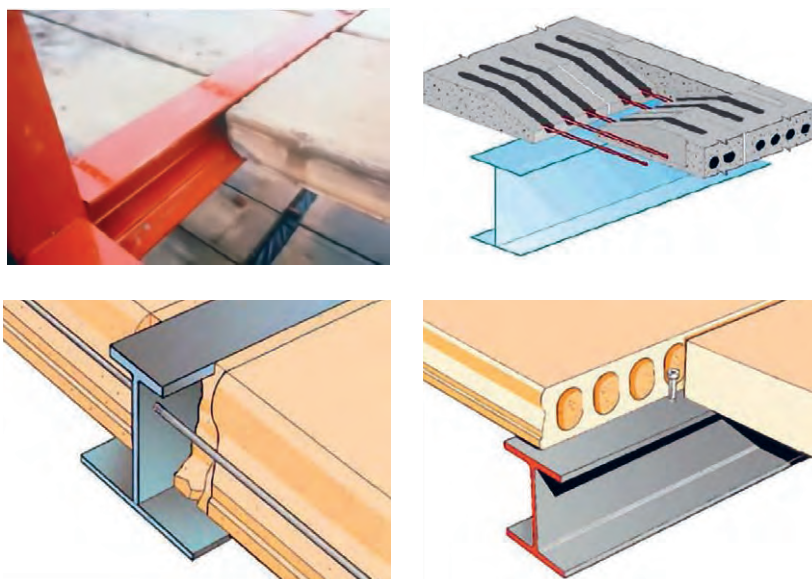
Примеры перекрытий из сборных пустотных плит
